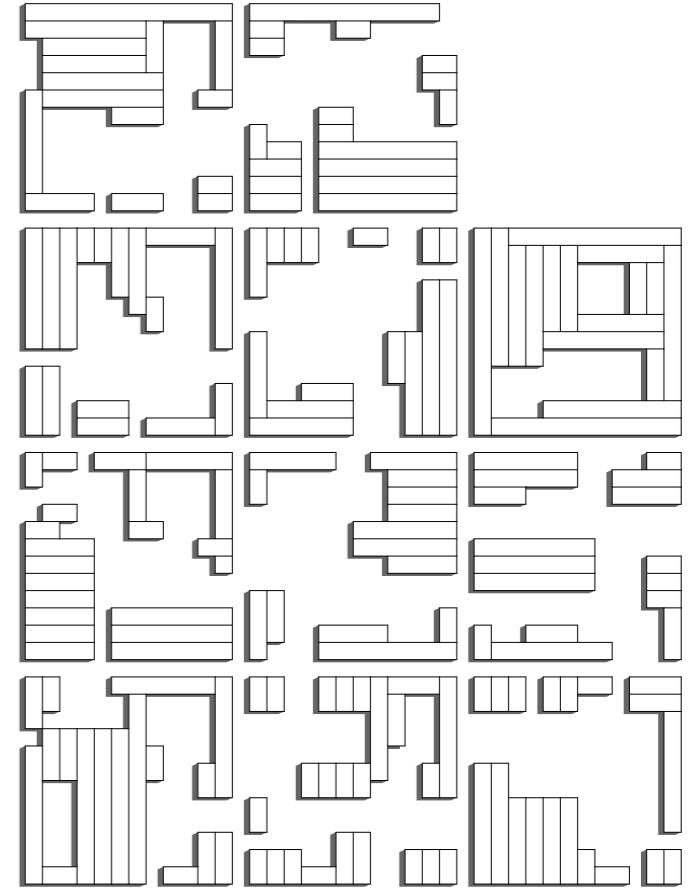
Secuencia de Plantas por nivel de pieza Final Wooden House.
